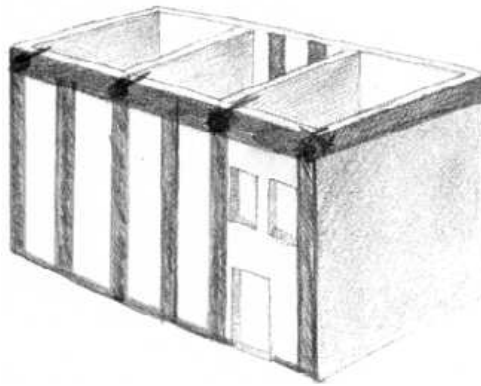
Schema di possibile soluzione di intervento per flessione verticale
